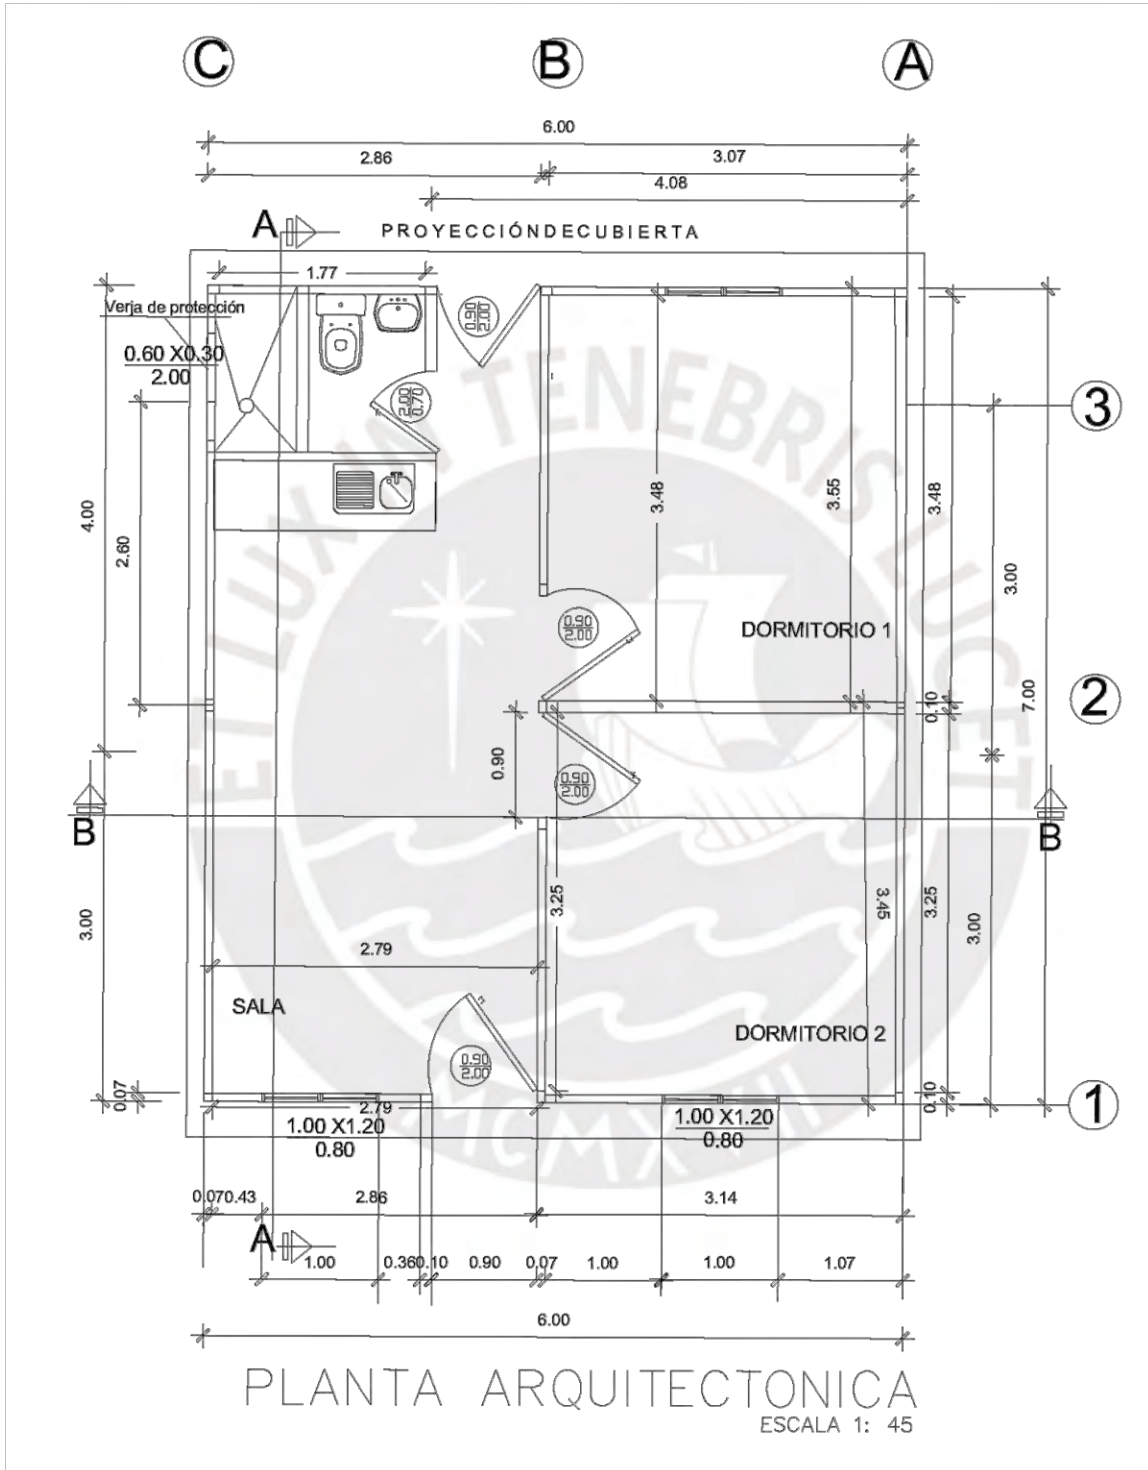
Plano de distribución en planta de la vivienda de bambú.
